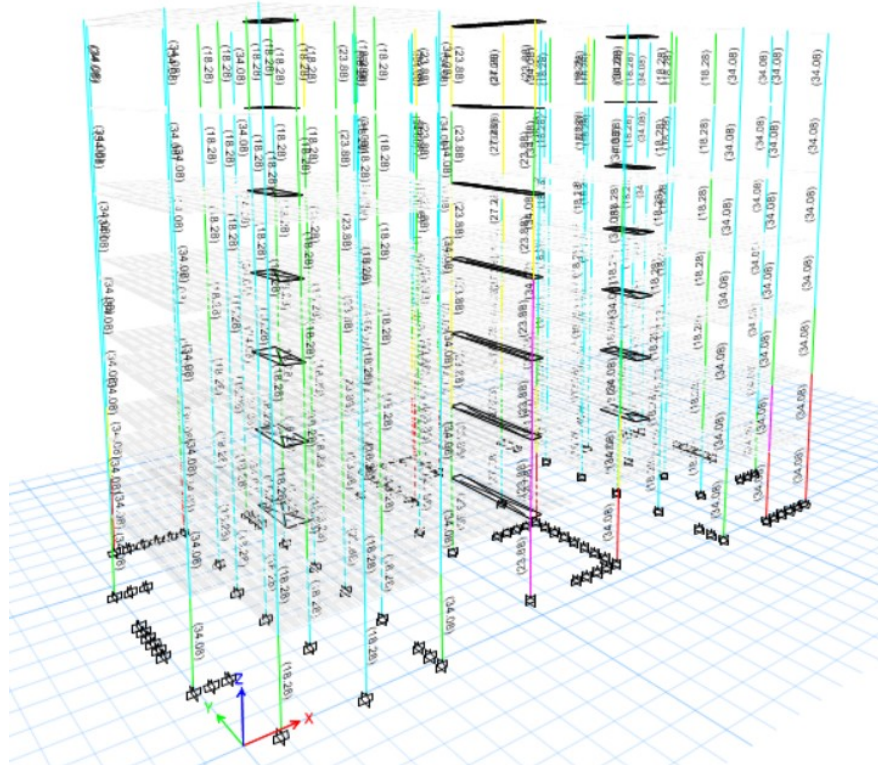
Diseño de acero longitudinal en columnas Sistema Dual - Edificio Blesser. Fuente: Elaboración Propia.
